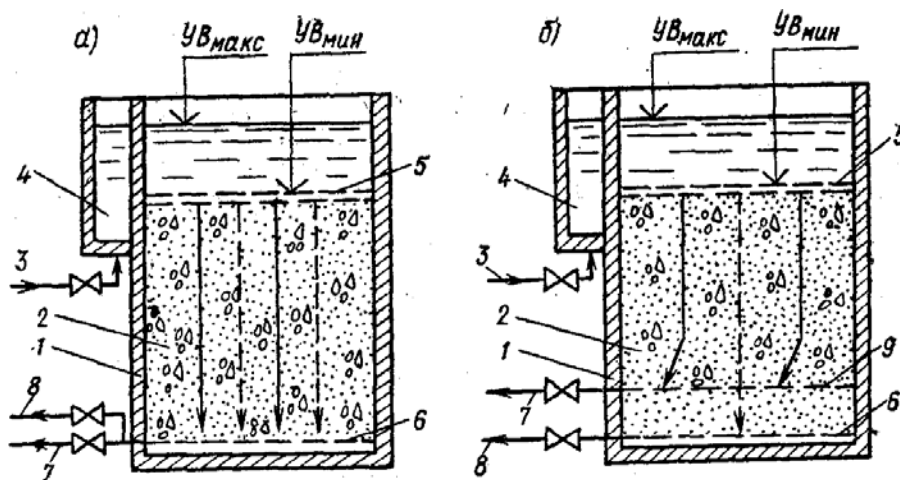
Фильтры с плавающей загрузкой конструкции ФПЗ:
